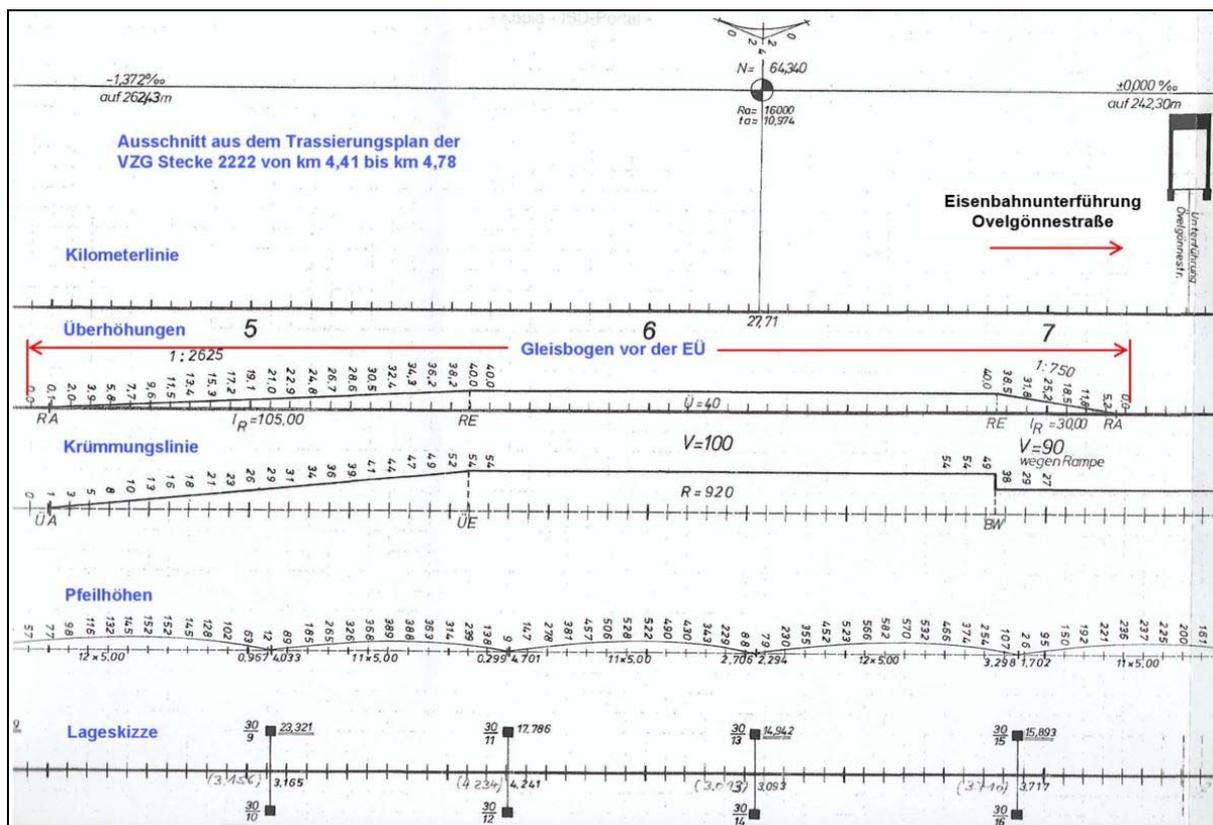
Ausschnitt 1 Trassierungsplan Strecke 2222
